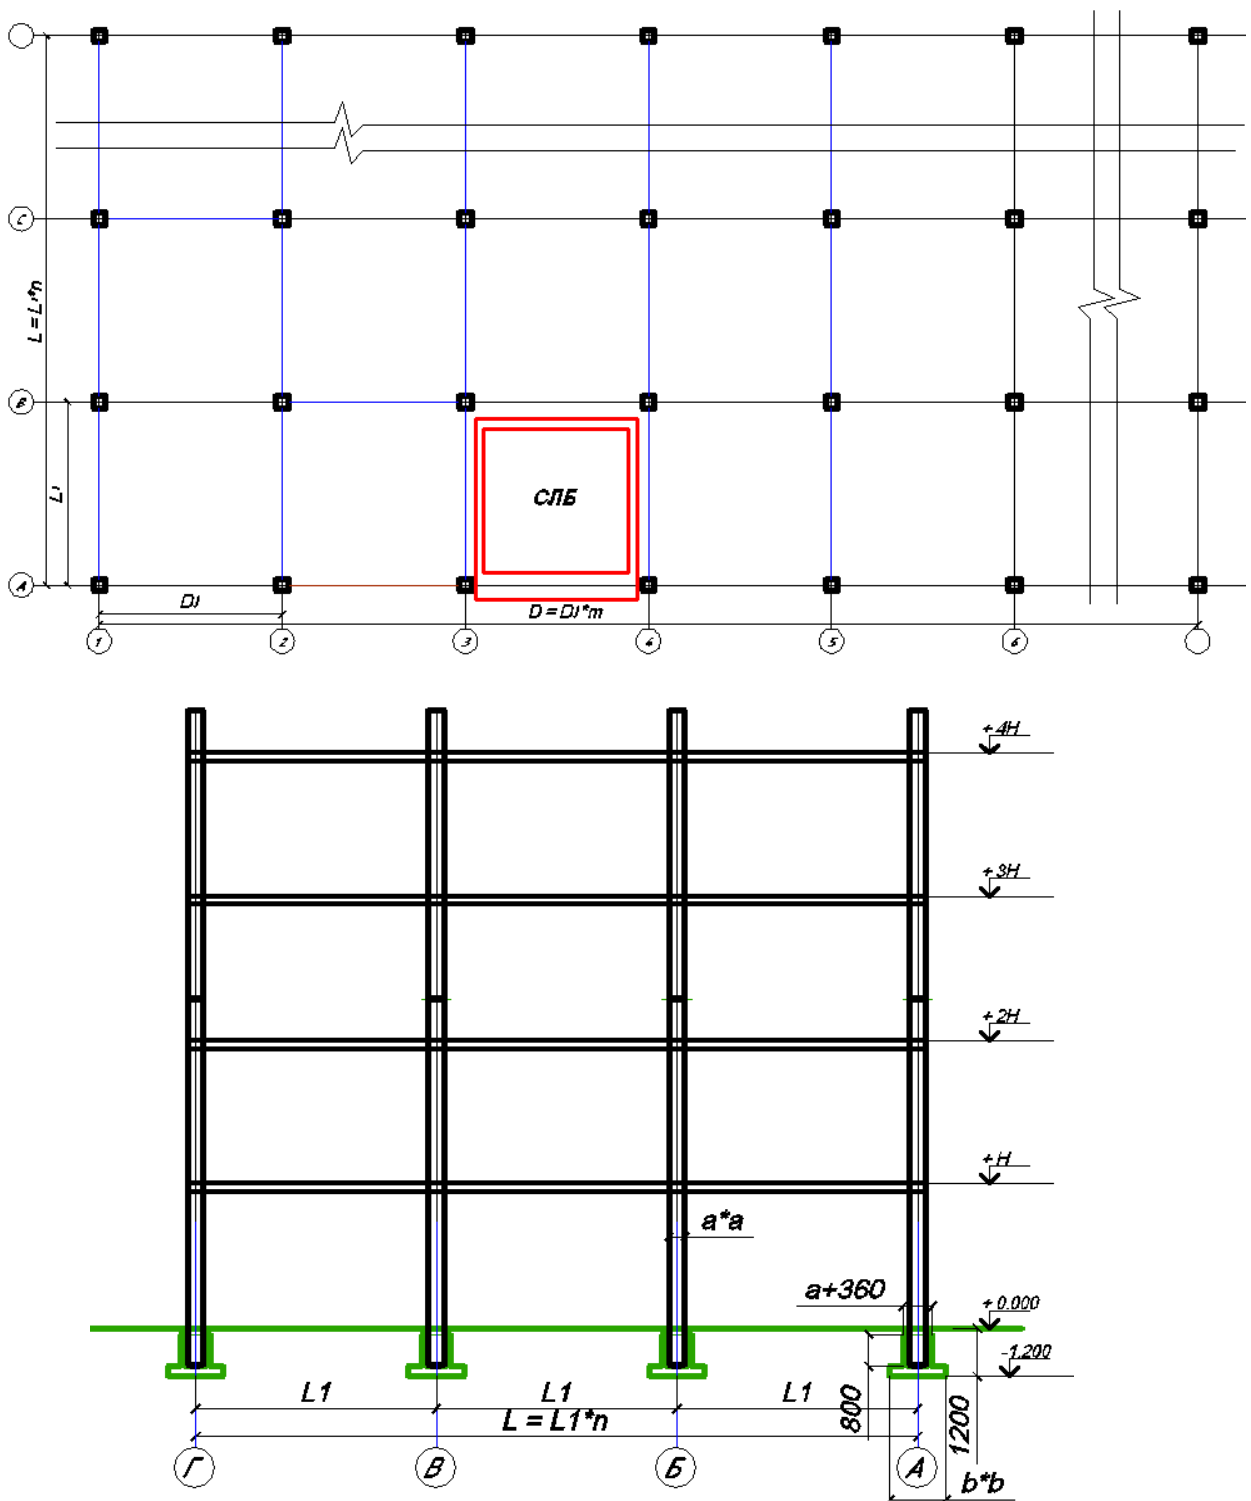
Схеми каркасної будівлі для вибору завдання на проектування
